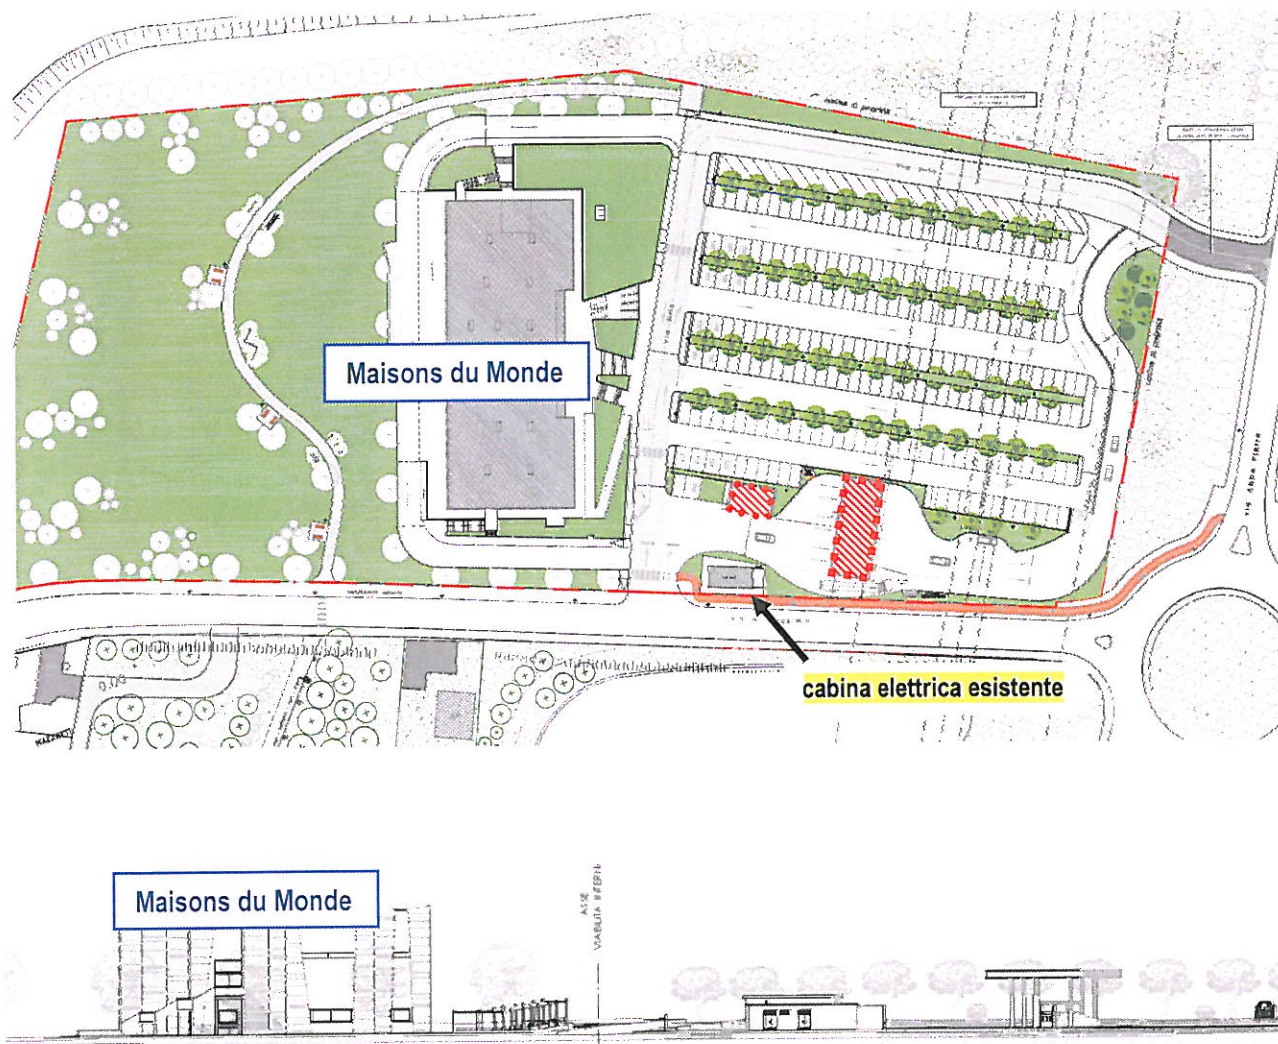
Planimetria e prospetto longitudinale dell'impianto di distribuzione carburanti (retino rosso) – via di Reggiana Sirio, Prato..
